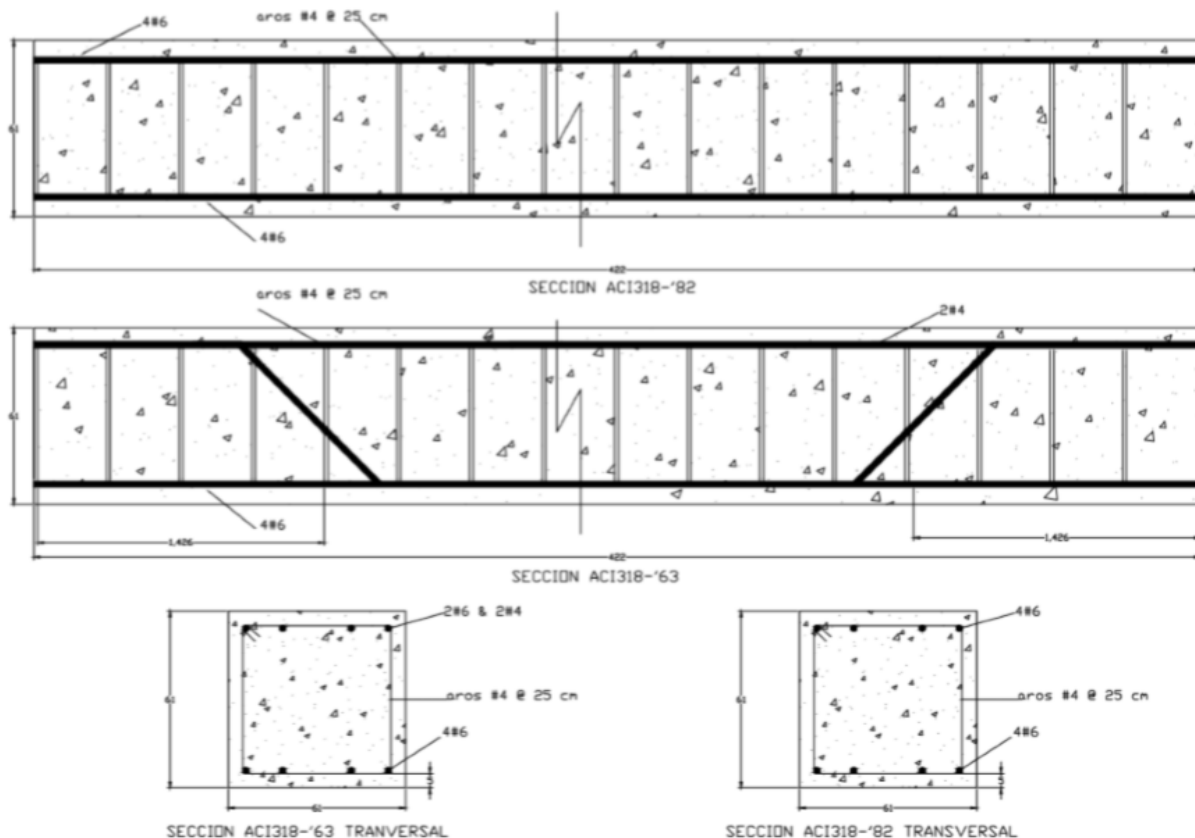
Detalle de la distribución del acero de refuerzo para la viga secundaria de la Pila 1 de quebrada El Fierro bajo dos distintos códigos de concreto estructural. Fuente: Elaboración propia.
